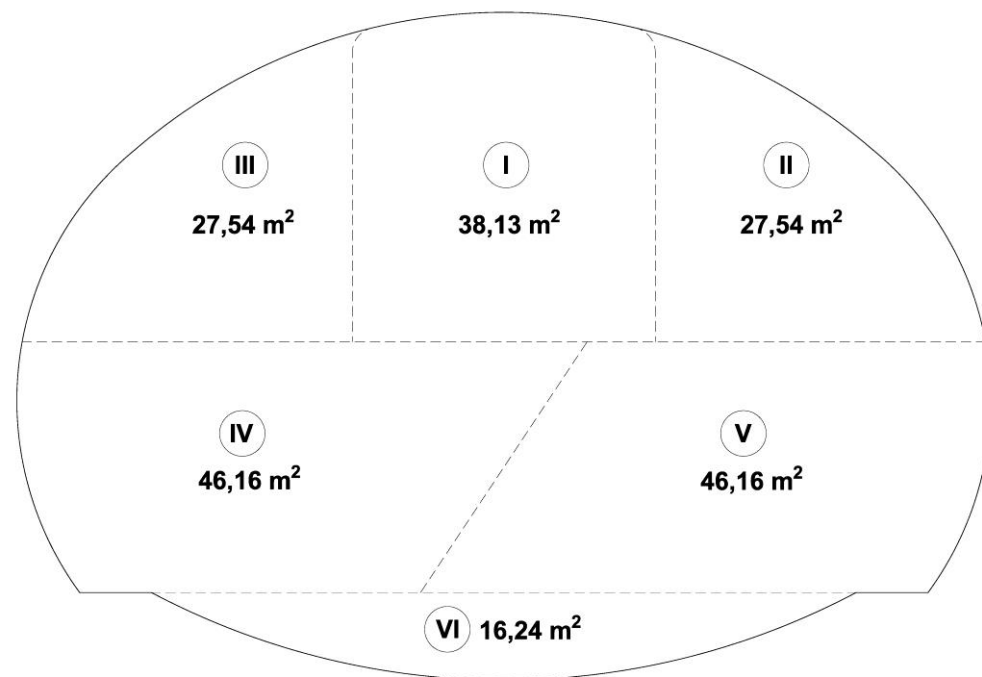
Fases constructivas previstas para la excavación de la Caverna (fuente: PC estación de Hospitales)
